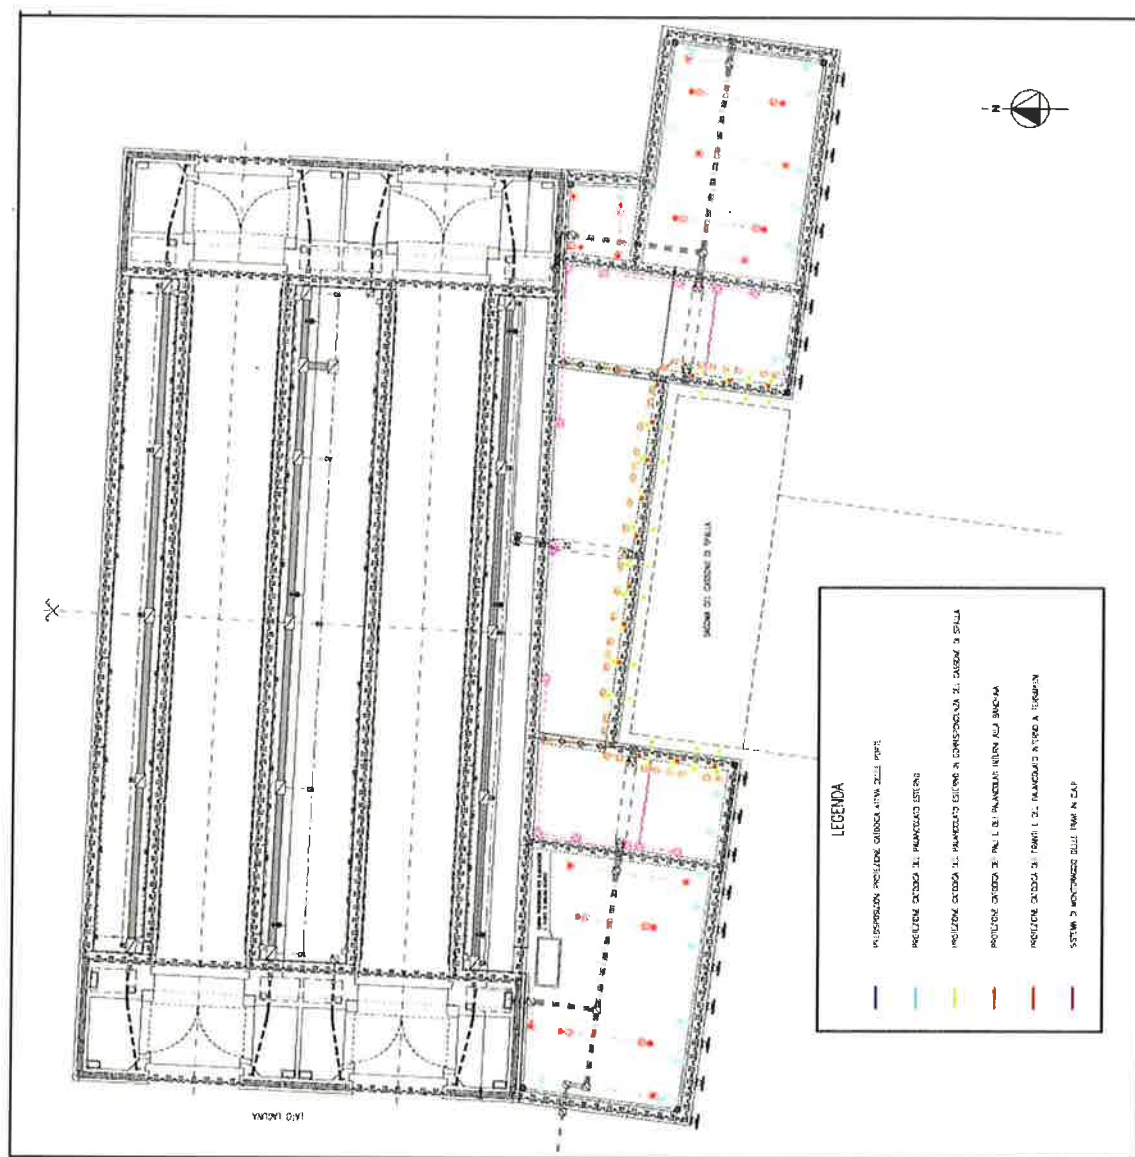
PLANIMETRIA DELLE OPERE SOGGETTE ALLE PREDISPOSIZIONI PER LA PROTEZIONE CATODICA DI WBE 01A
